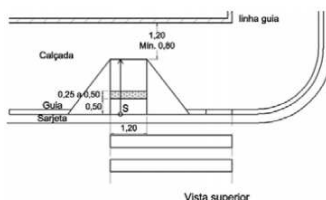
Sinalização tátil de alerta nos rebaixamentos das calçadas — Exemplo
